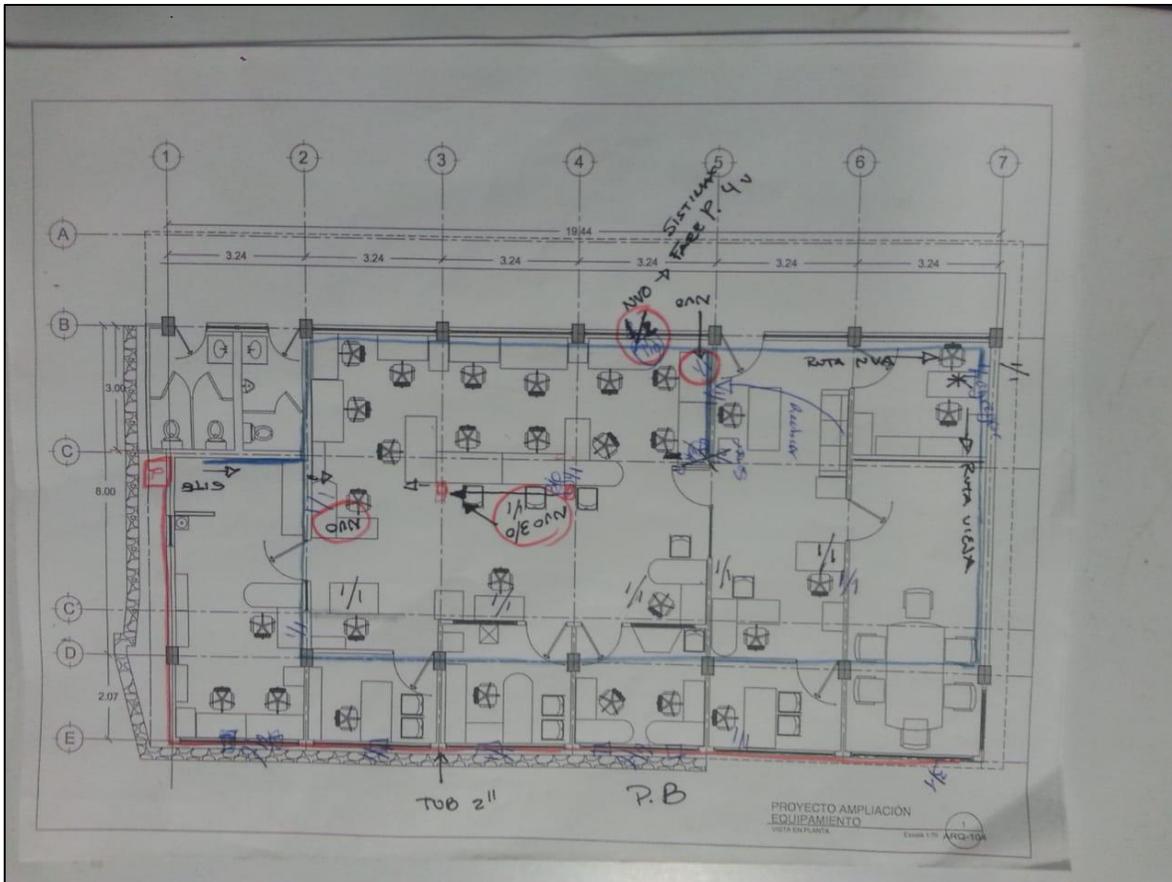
Primer levantamiento de necesidades de la planta baja Noria Alta
